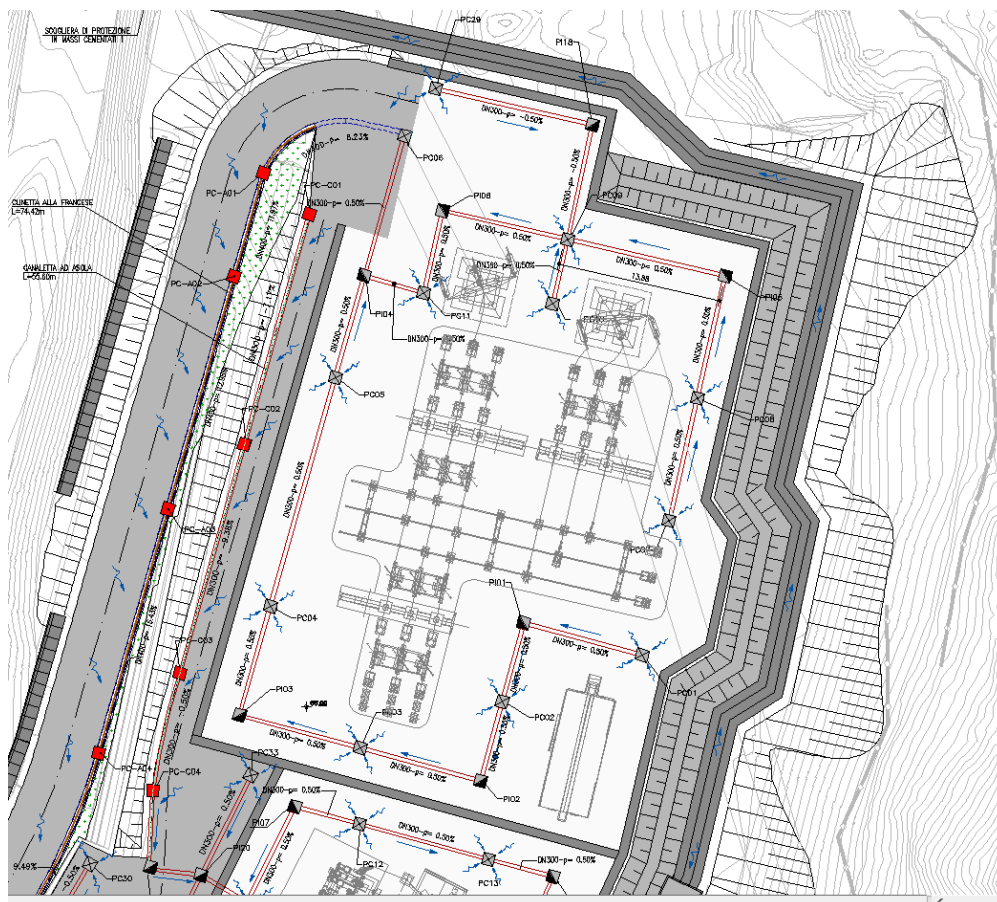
Regimazione acque di piazzale – Stralcio planimetrico
